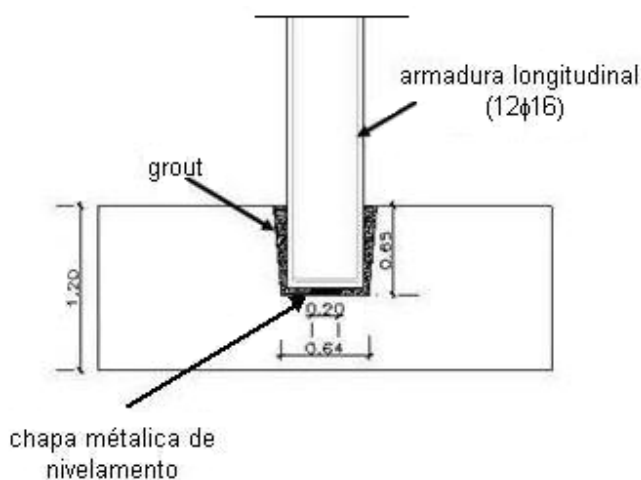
Esquema da ligação Pilar - Sapata com Copo
